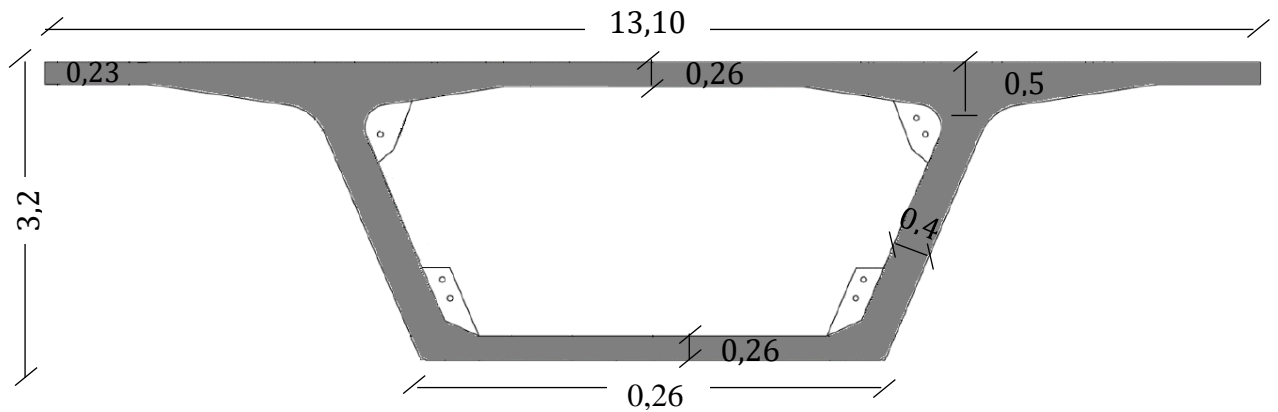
Coupe transversal (coupe 01) du voussoir courant (typique)
